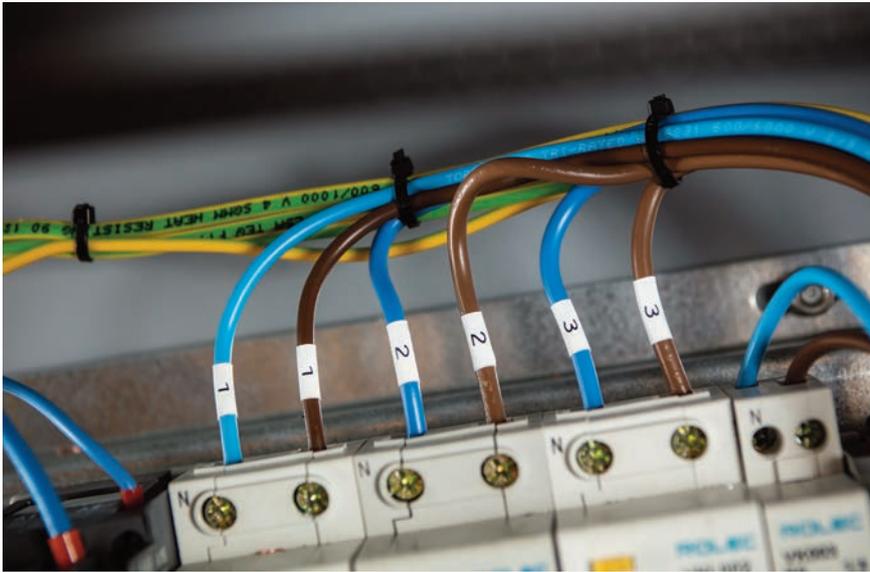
| Mit Schrumpfschläuchen ist es sehr einfach möglich, eine flexible und normgerechte Beschriftung zu realisieren.
